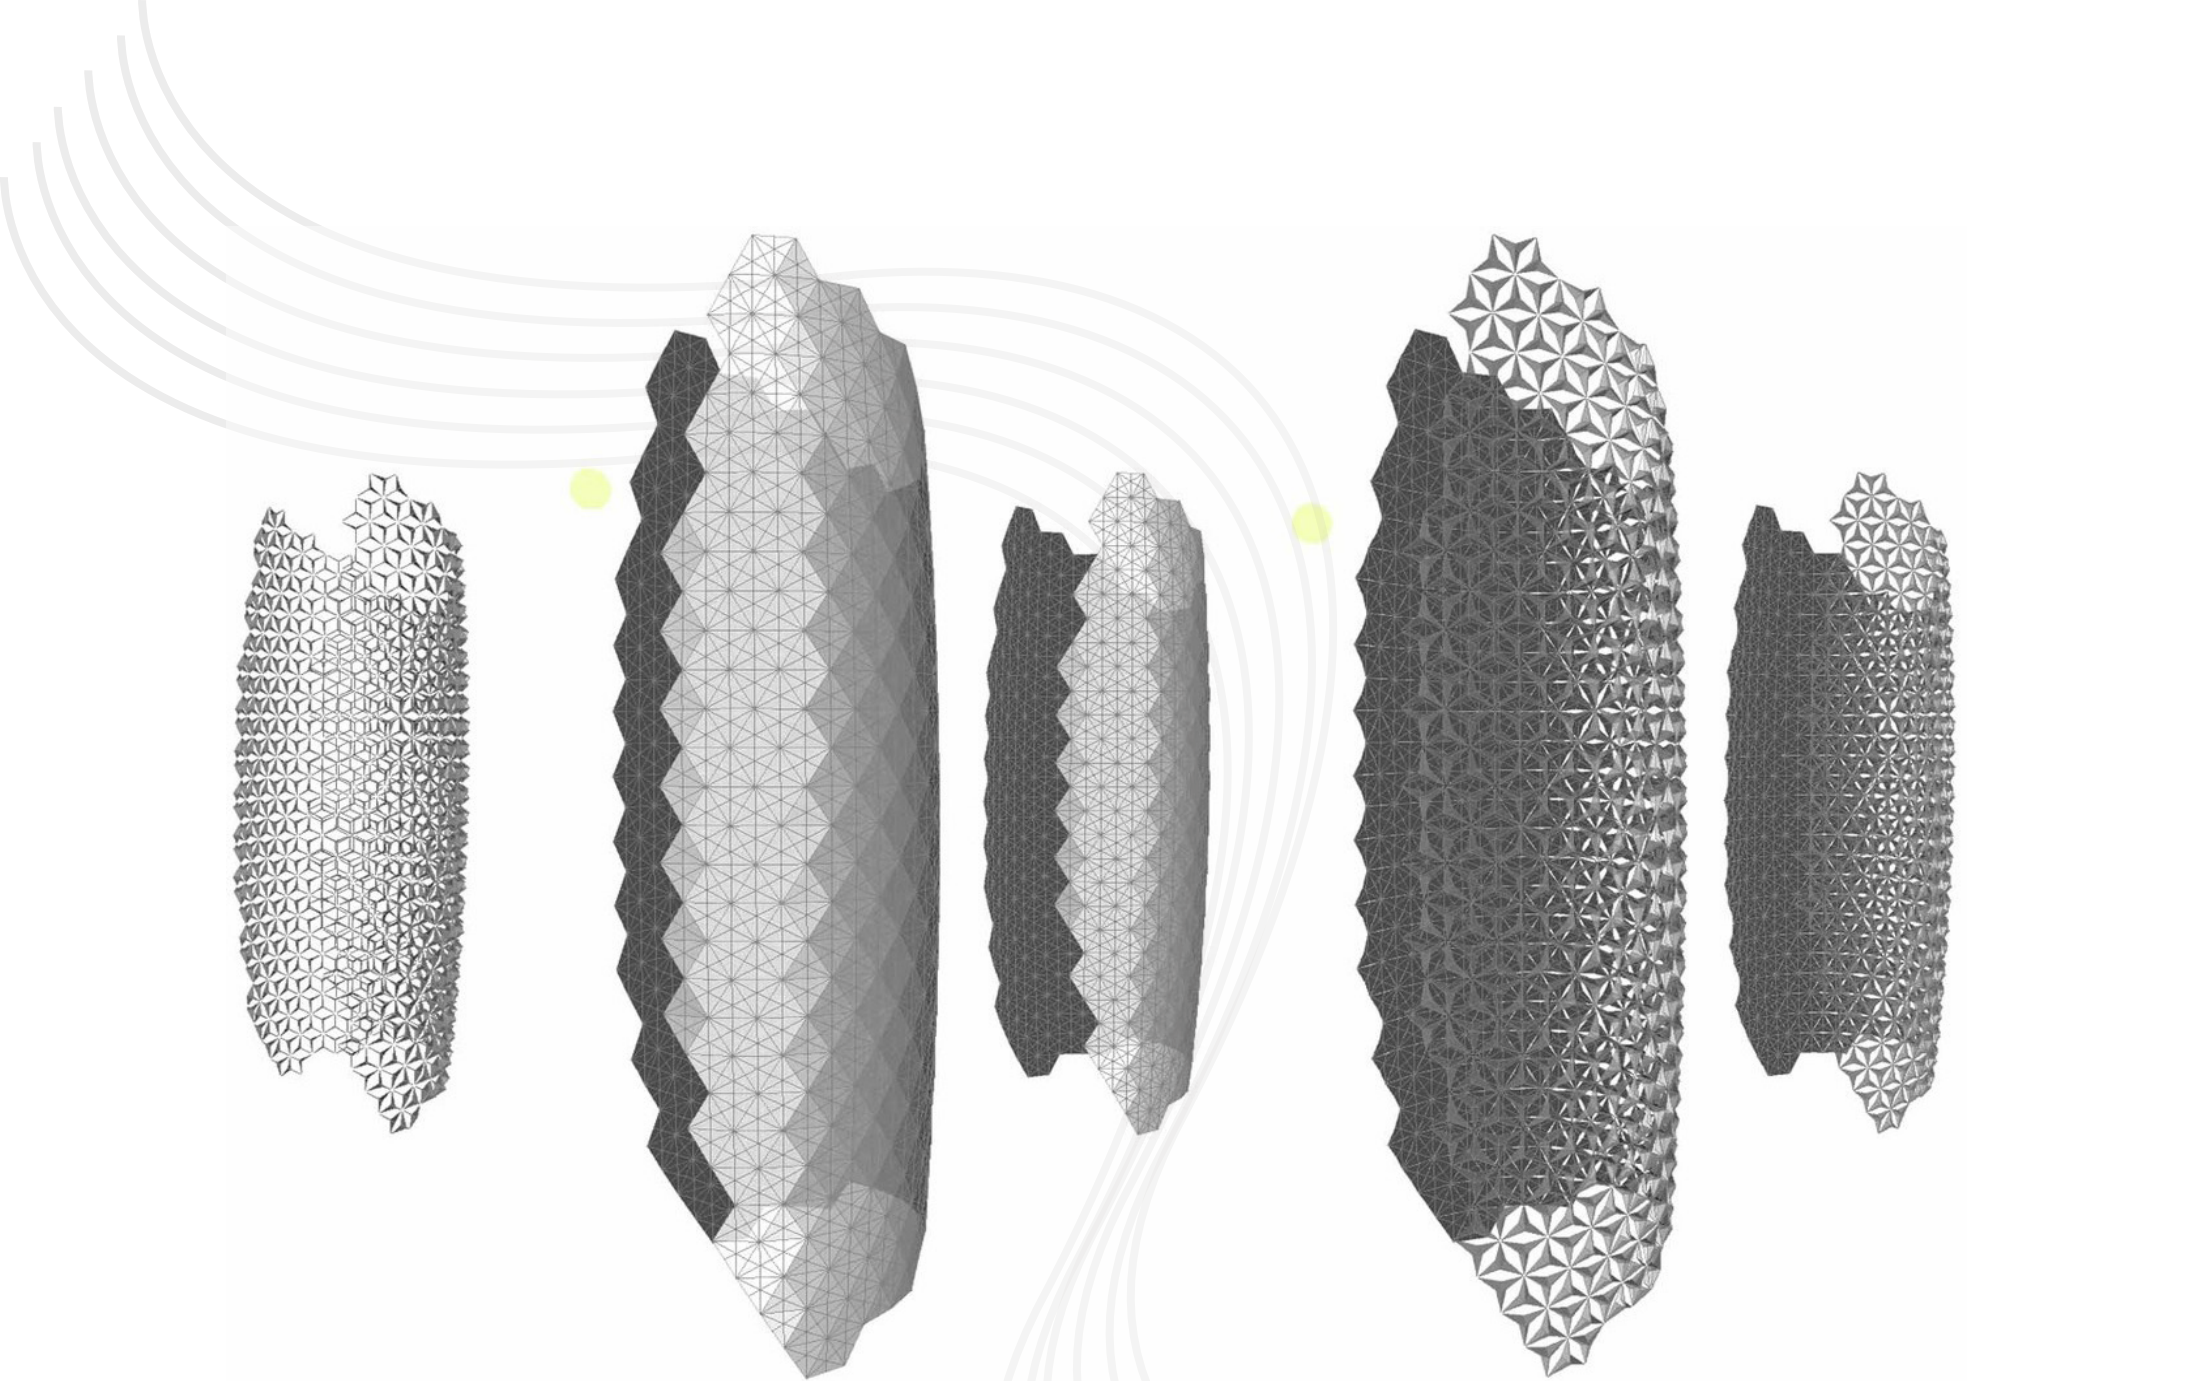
Edificio Albahar towers detalle de la cobertura del exterior
